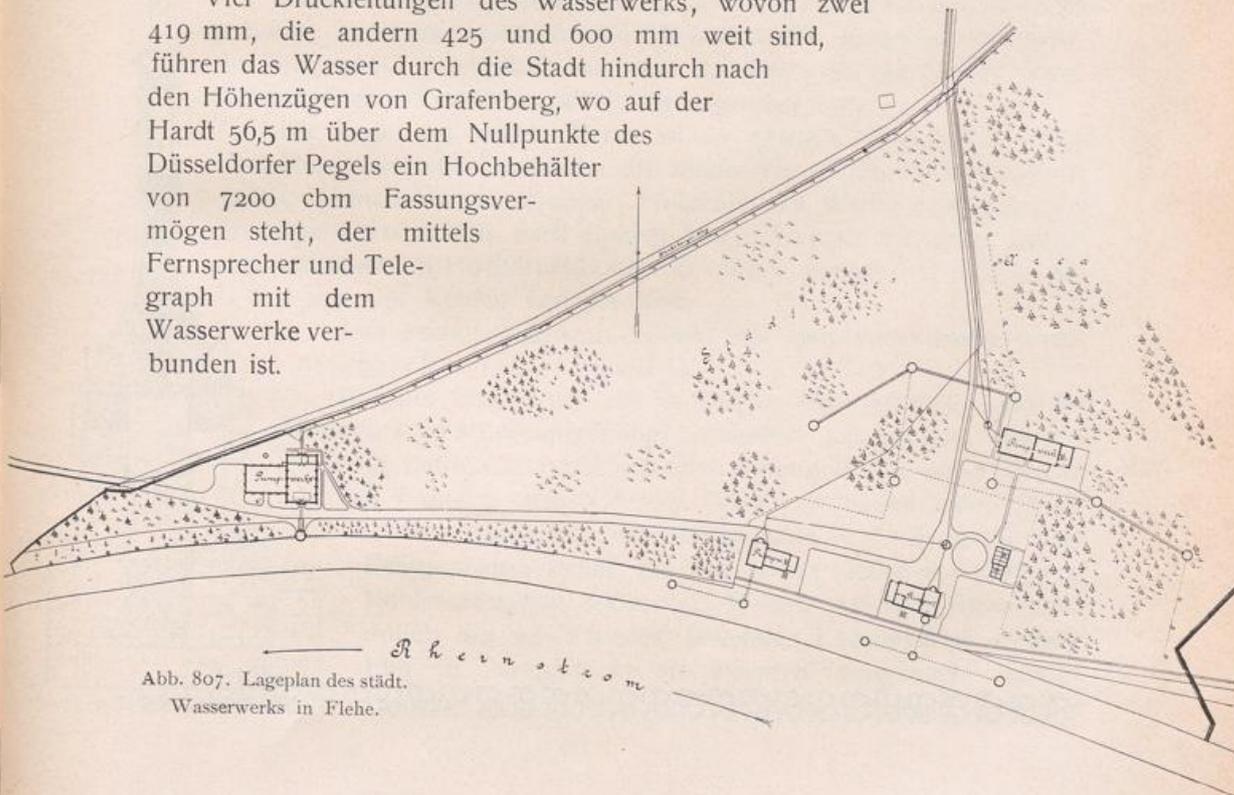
Lageplan des städt. Wasserwerks in Flehe.
